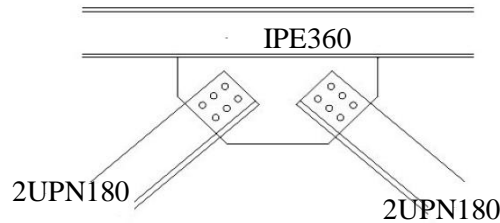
Assemblage gousset –contreventement à la poutre.
